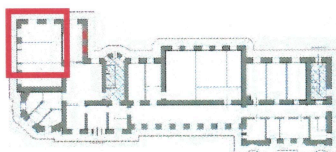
План с обозначением кирпичных перемычек оконных проемов
